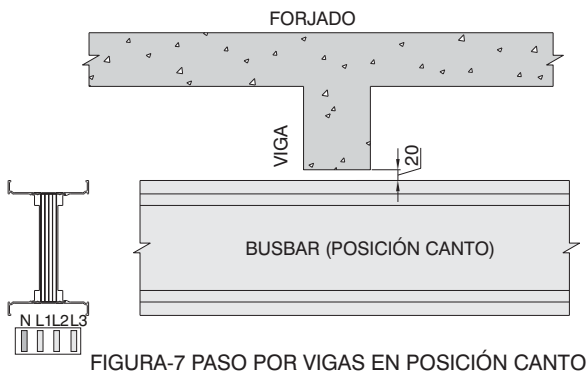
PASO POR VIGAS EN POSICIÓN CANTO
